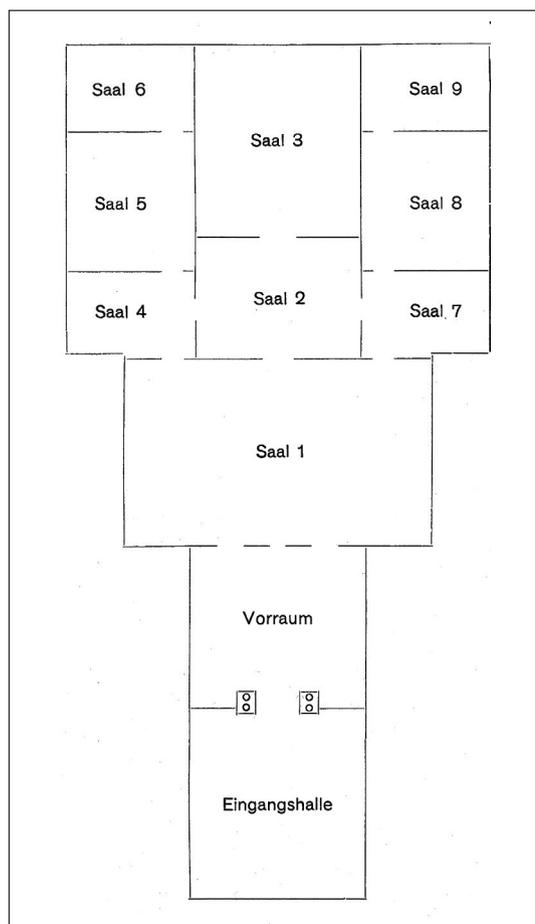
Grundriß der Ausstellungsräume, 1908.
